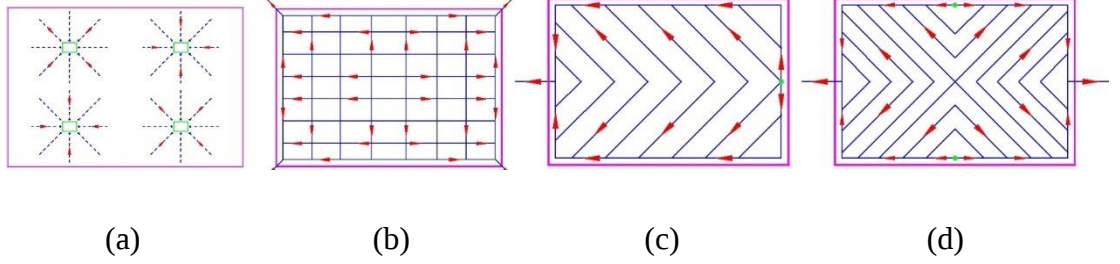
Futbol sahalarında yerüstü drenaj sistemleri; (a) çatı, (b) piramit ve (c) balıksırtı
